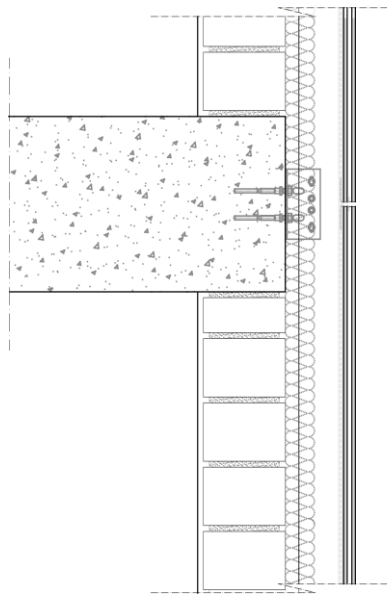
Sección vertical. Faveton® SAH Acqua 20-V.
